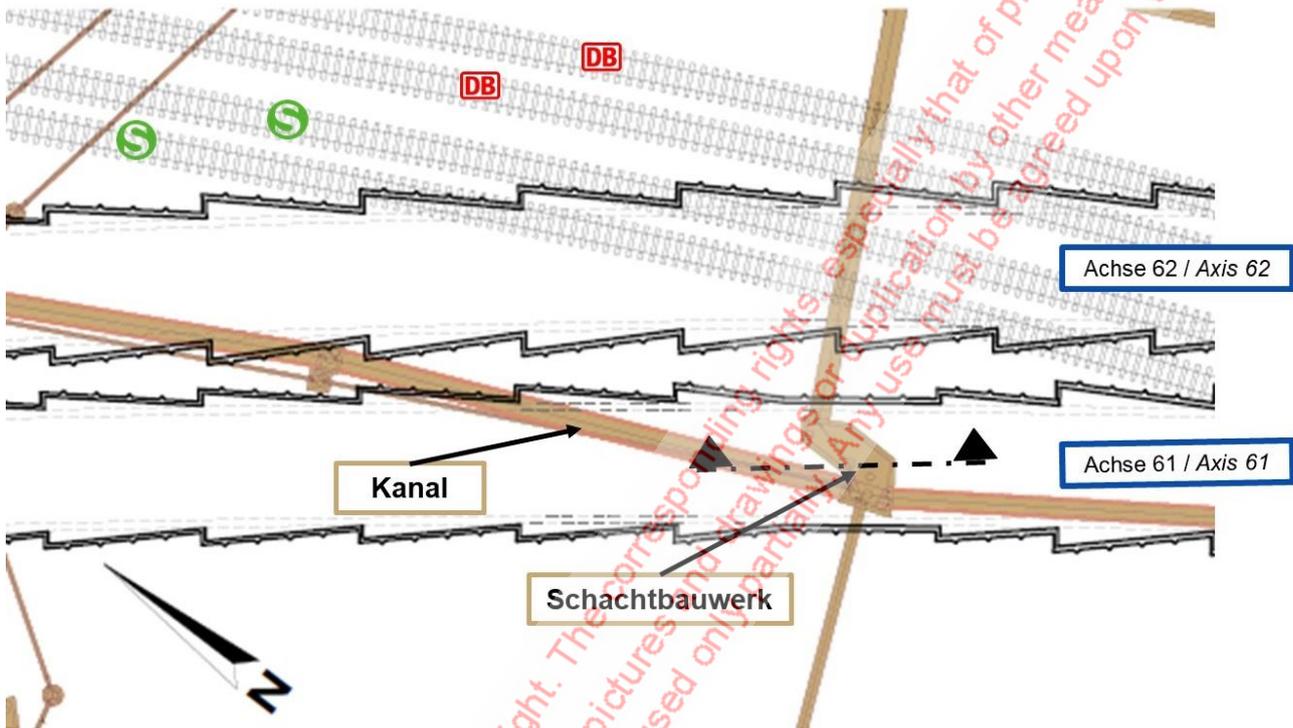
Unterfahrung SES Kanal, Lageplan, Ausblick
